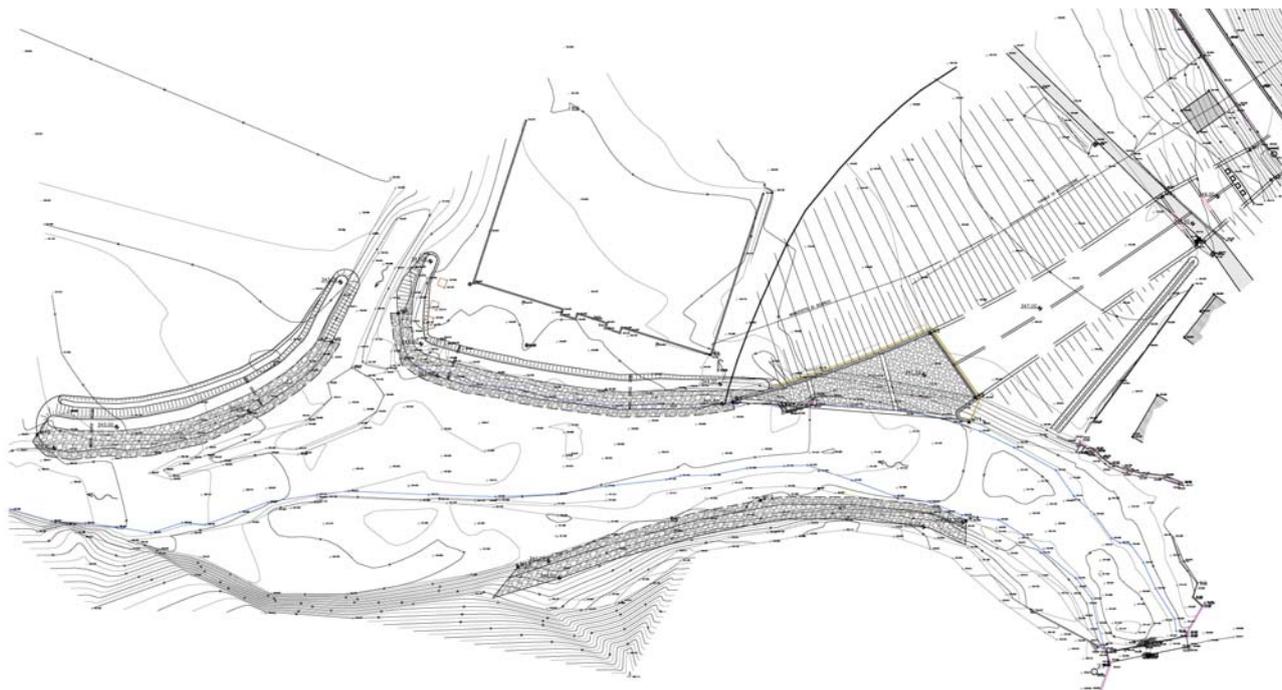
planimetri opere di restituzione e di protezione confluenza galleria di by-pass / Chiese
